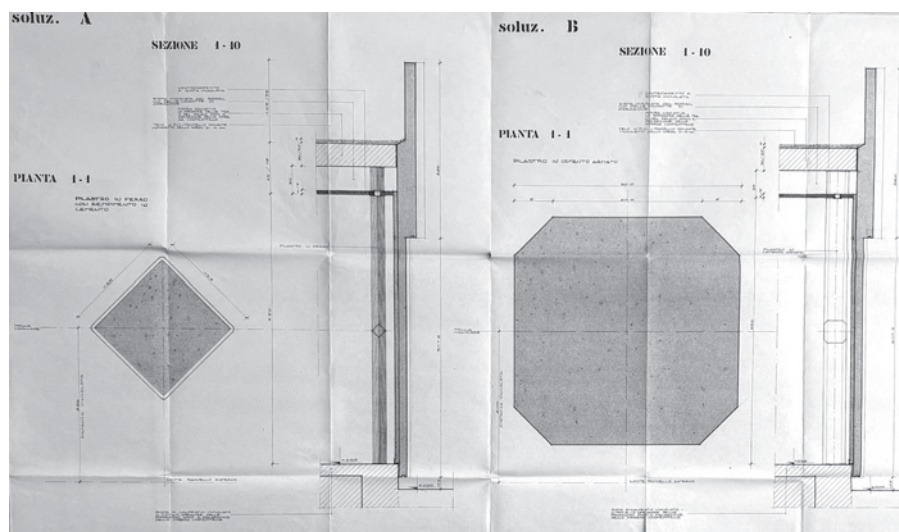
Progetto programma. Esecutivo architettonico. Sub-sistema struttura, soluzioni per schema in acciaio e in calcestruzzo armato (ASF, b. 147A)
